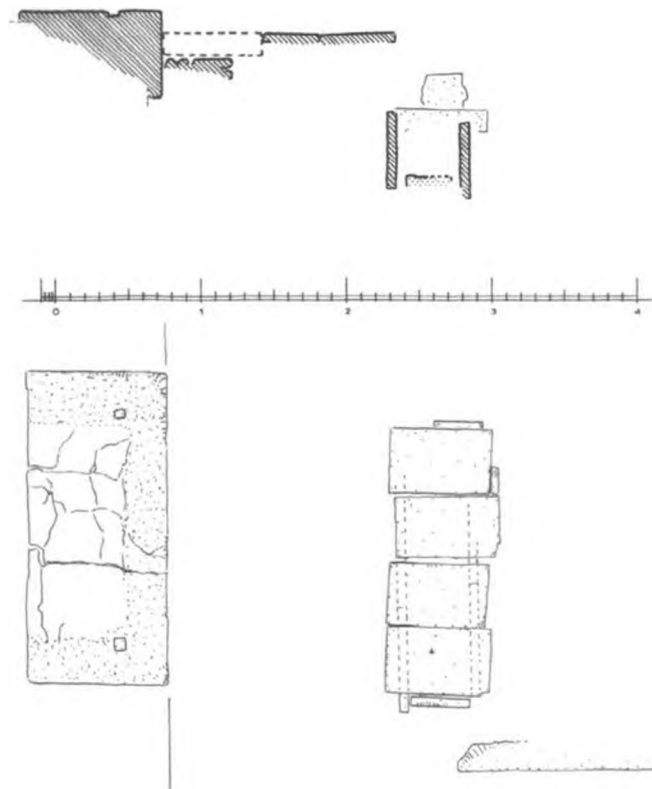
Grabanlage vor der Südtür der Hauptkirche. Grundriß und Schnitt
